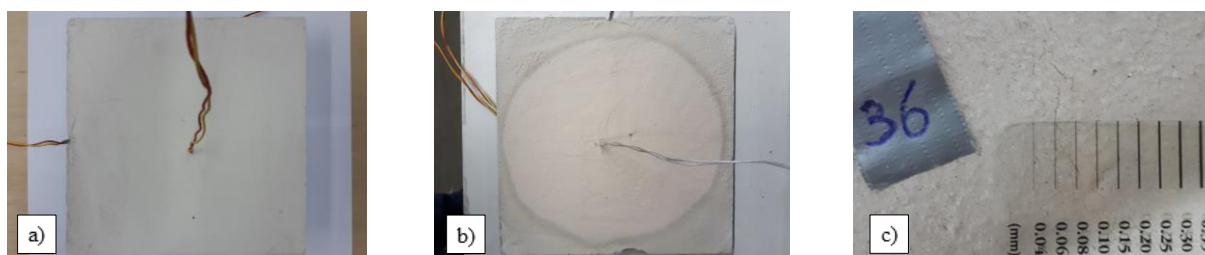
Provete P_A3_2_LA: a) Provete antes do ensaio; b) Provete após o ensaio; c) Fissuração do provete após o ensaio.
